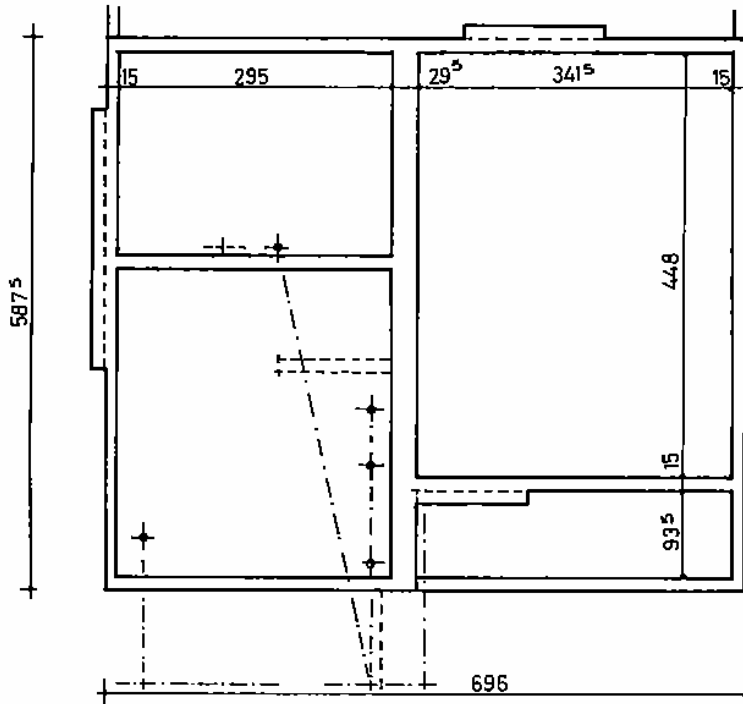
Plans des fondations. En haut, béton de propreté coulé en rigoles recevant une longrine en béton armé (plan du bas).
